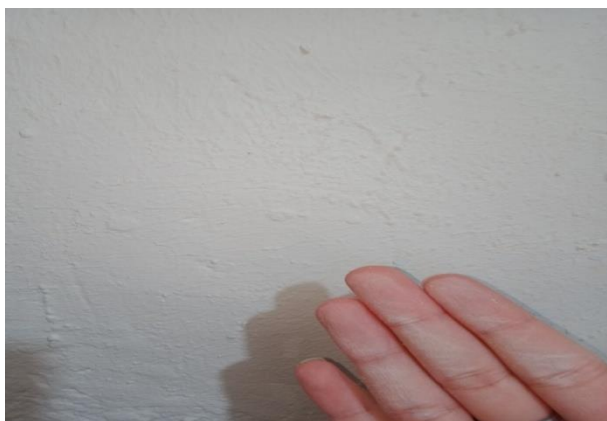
Détection de la présence d'un farinage sur une façade peinte (par rabah ben abbes et zekraoui)
